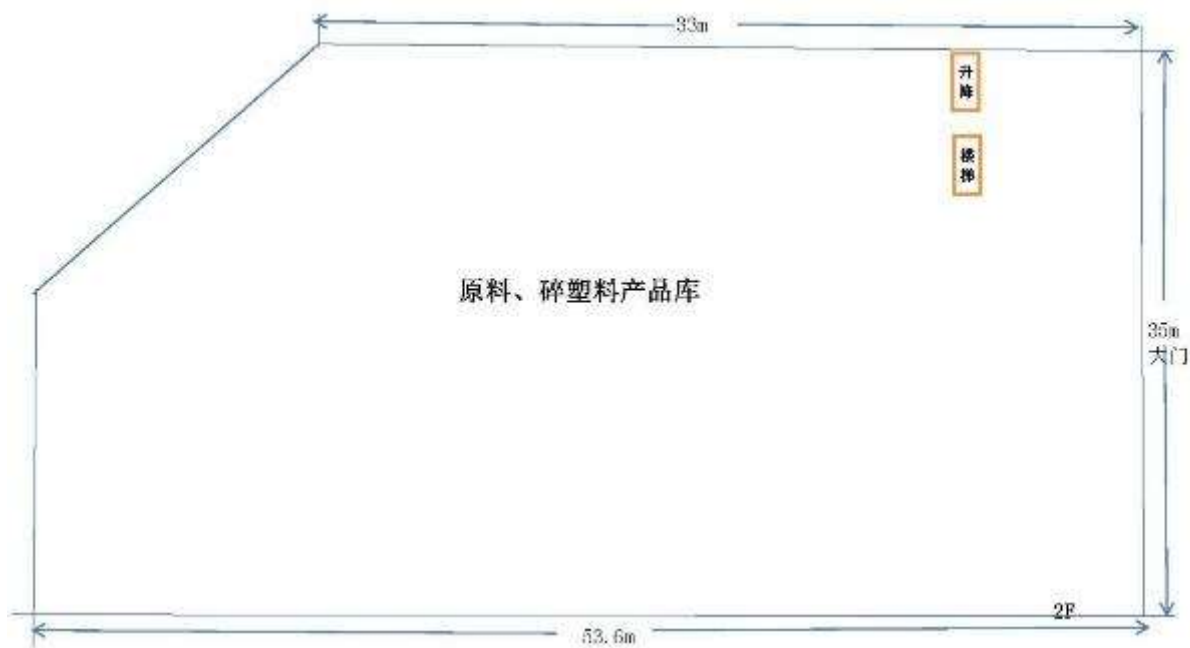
搬迁及改扩建后北厂区 3#厂房二层平面布置图
